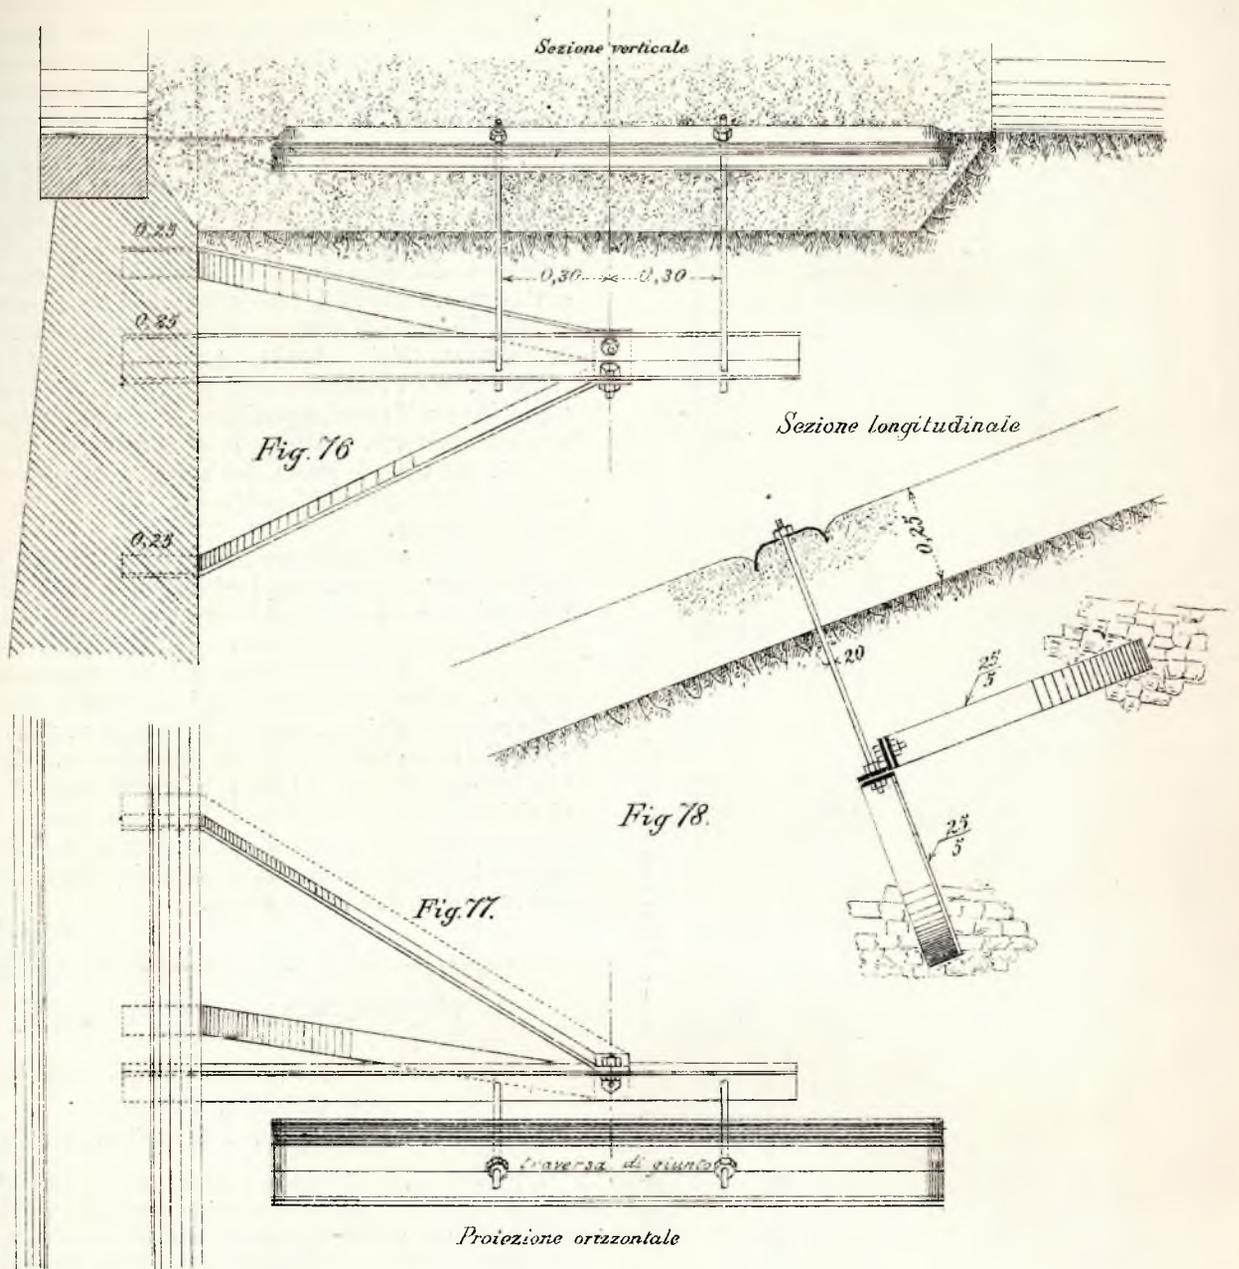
Ancoraggio del binario. — Tipo per rilevato con muro di sostegno.
